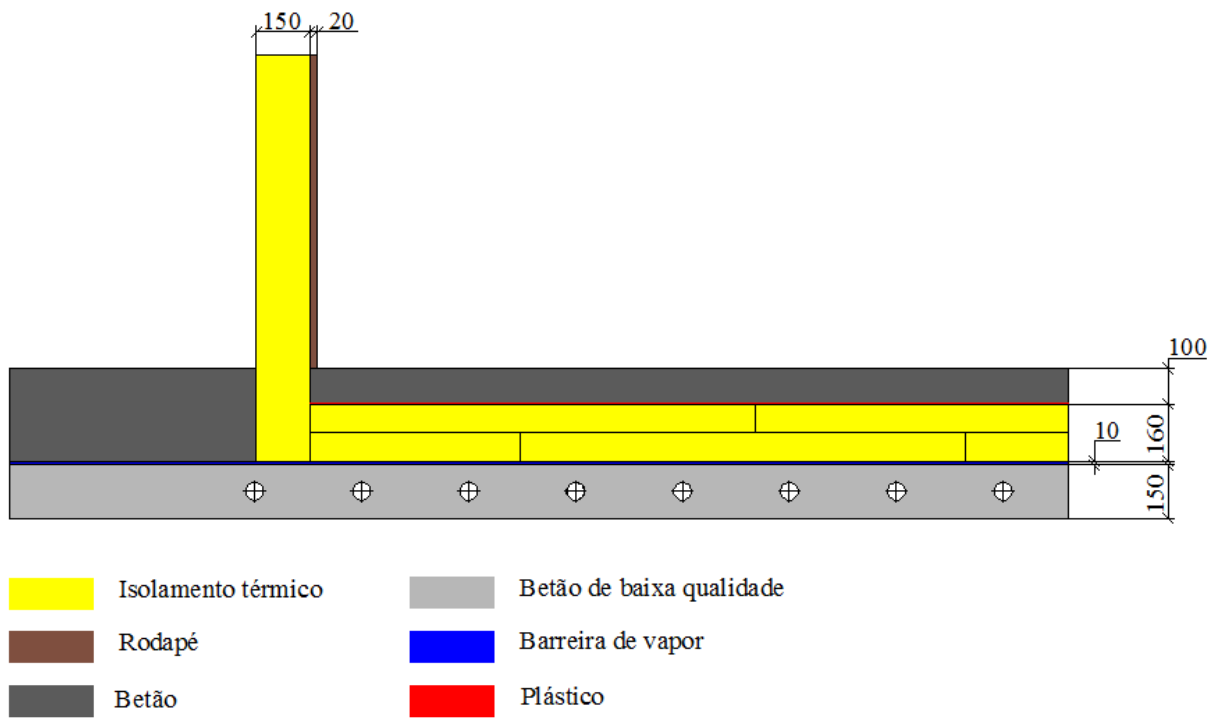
Detalhes da execução do pavimento da câmara frigorífica, cais e antecâmara
